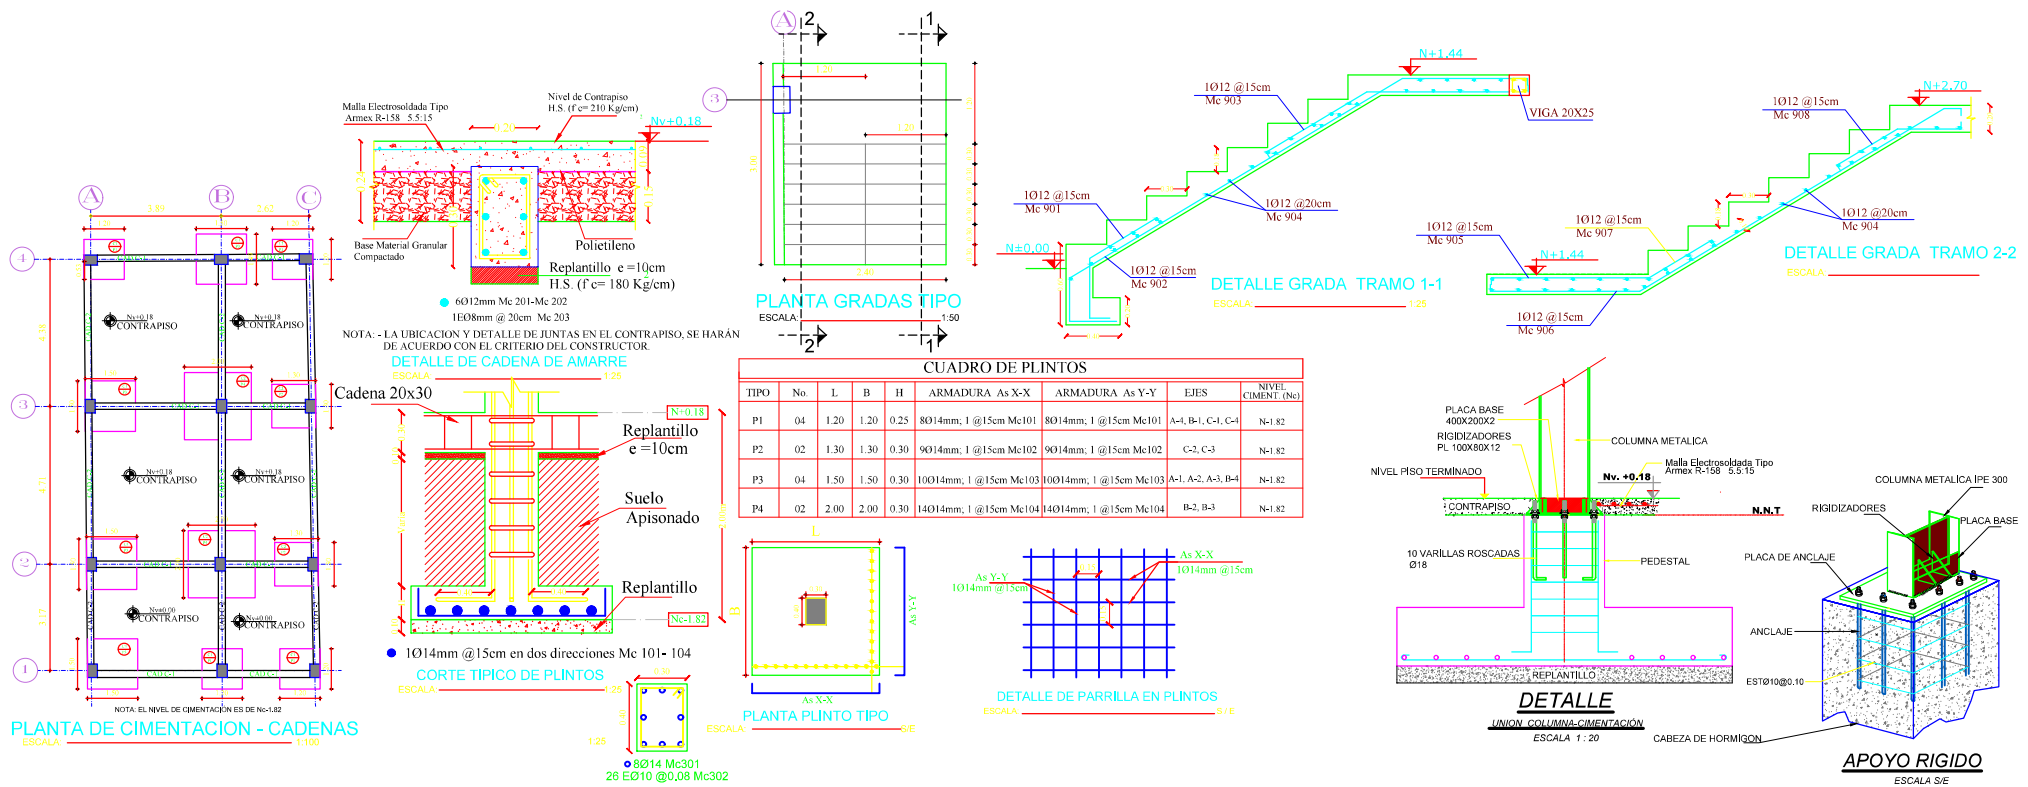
Sistema de cimentación y anclaje de la variante estructural del edificio base.
